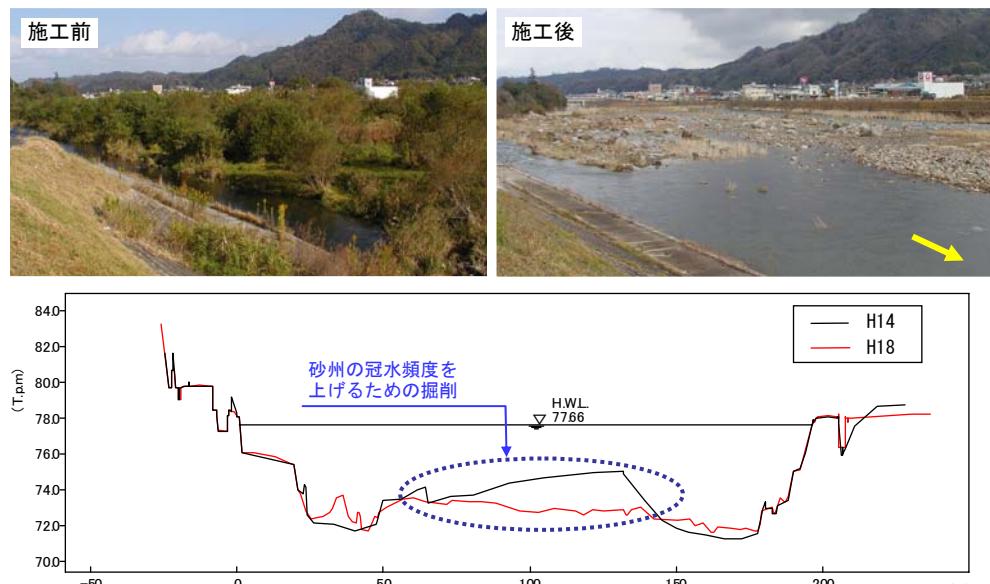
河床掘削の試験施工（日野川本川 16.0k 付近）
